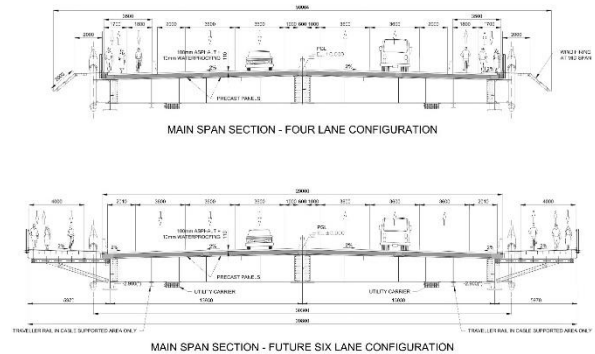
Sección transversal típica del tablero, para las configuraciones de 4 y 6 carriles
